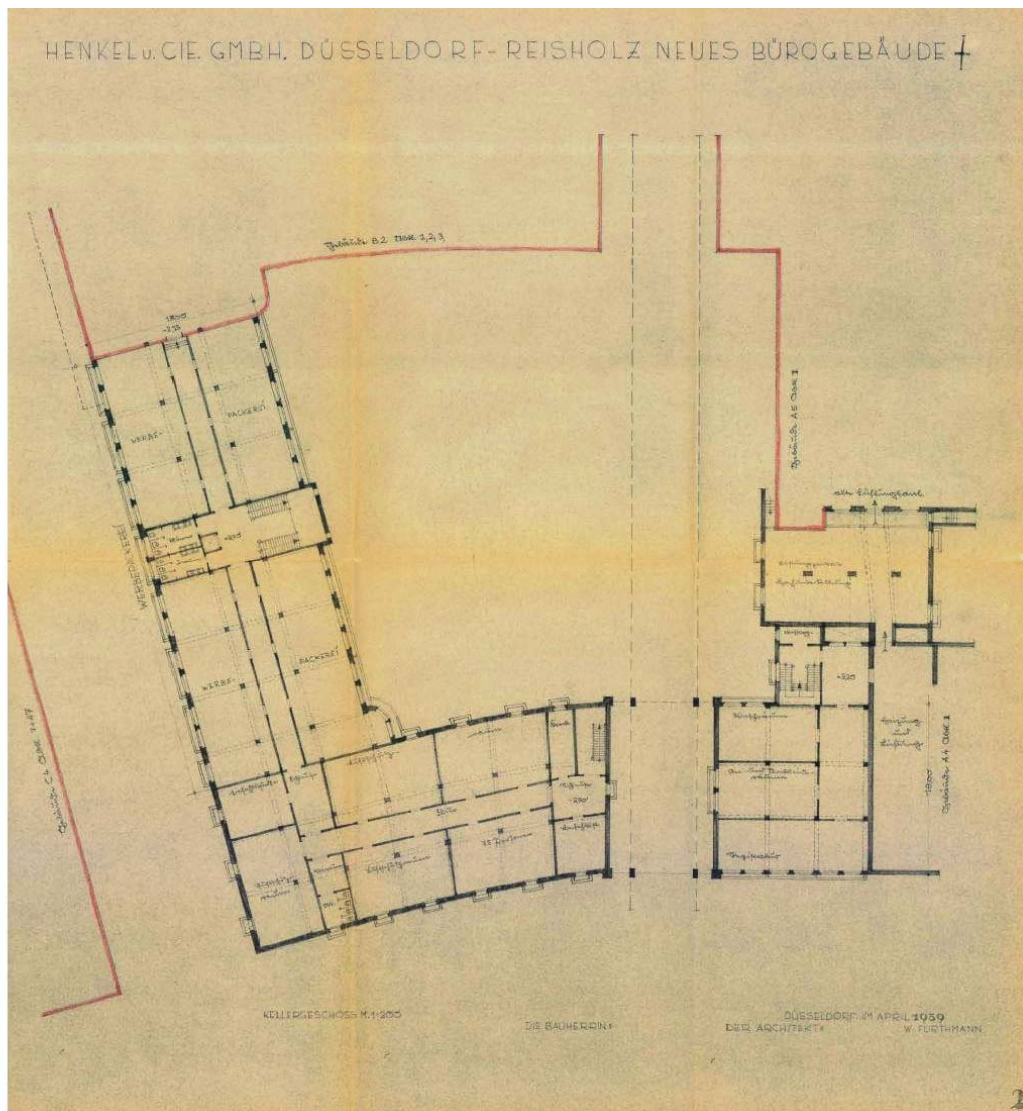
Entwurf zum Bürogebäude, Grundriss-Kellergeschoss, April 1939 – Architekt: W. Furthmann
